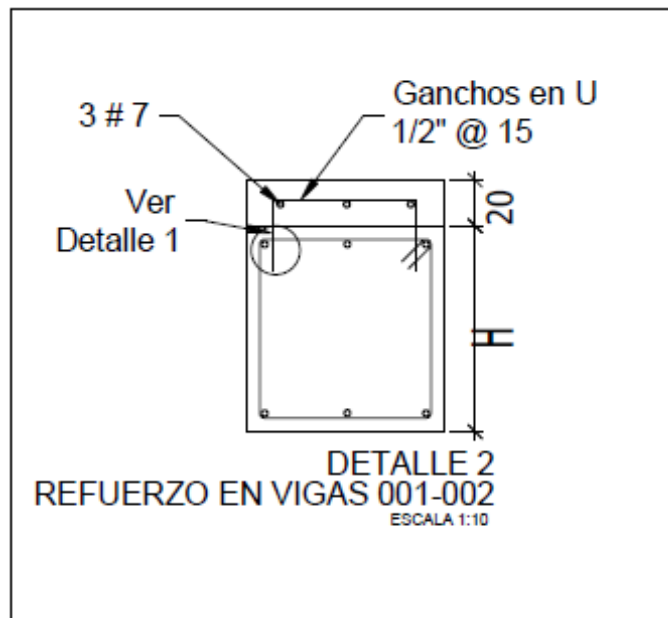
Detalle de las de los ganchos para los anclajes a las vigas.
